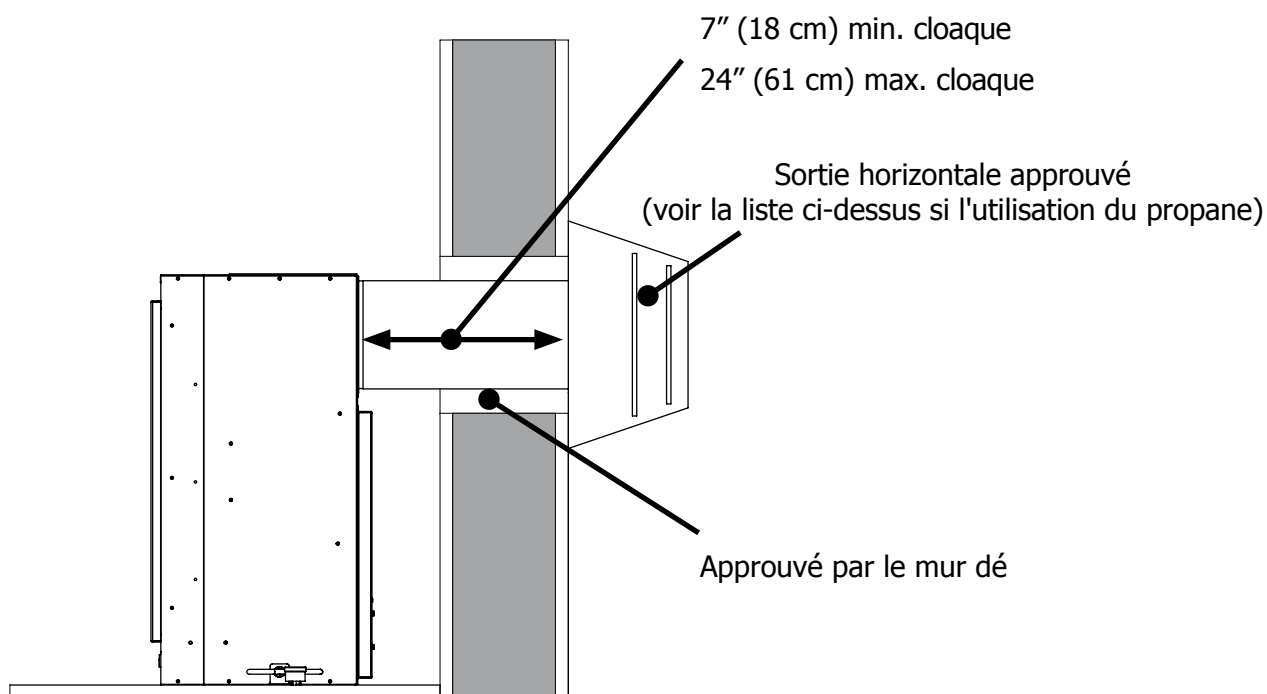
Appartement à évent mural arrière - Aucune élévation verticale
